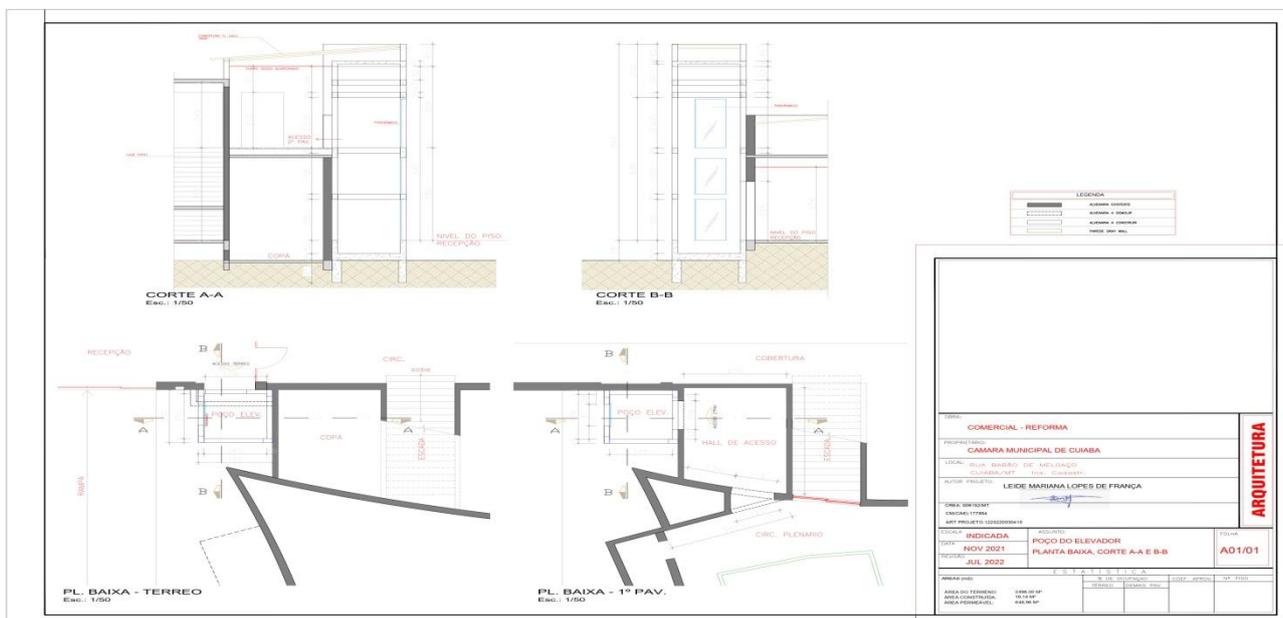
Projeto Arquitetônico com a indicação do local onde o poço será construído para instalação do elevador.
